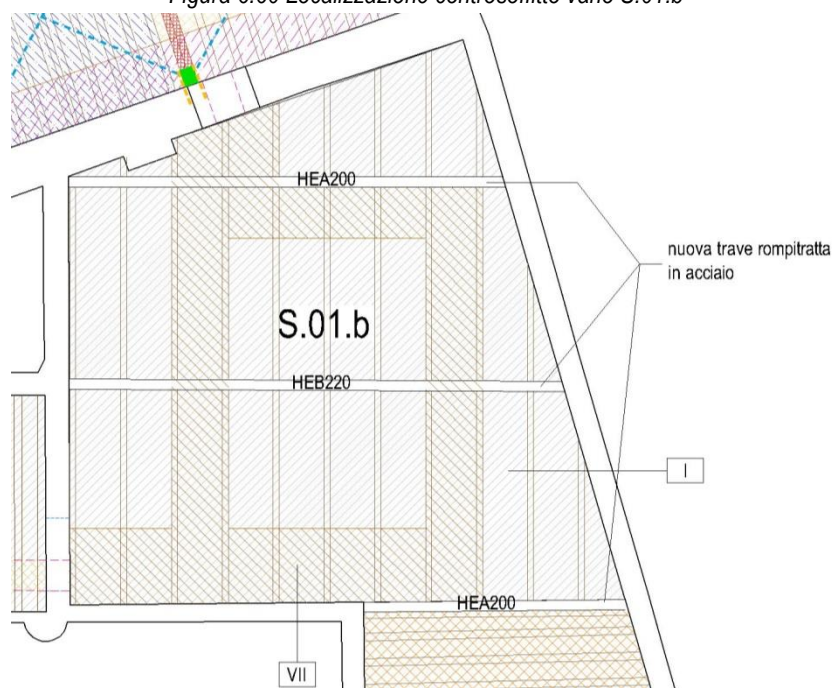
Pianta strutture controsoffitto vano S.01.b
